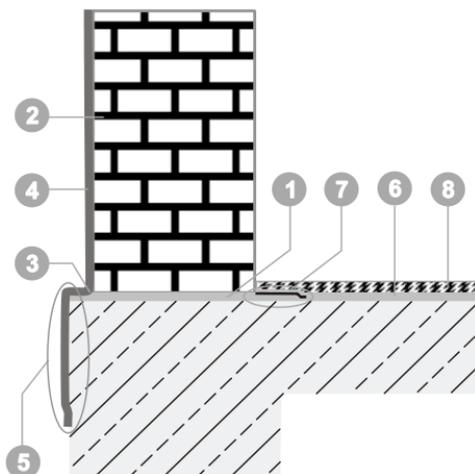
Гидроизоляция с использованием ШЛАМОВ К11:
